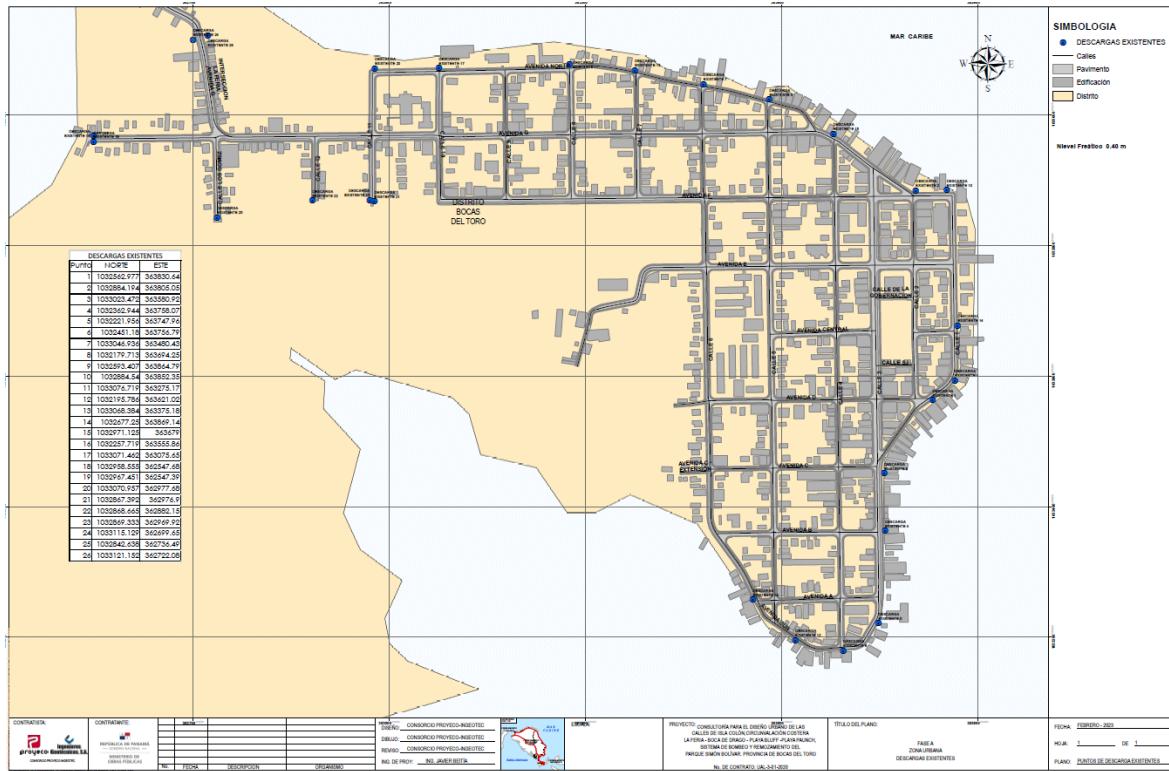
Plano de ubicación de descargas existentes (Anexo 11)
